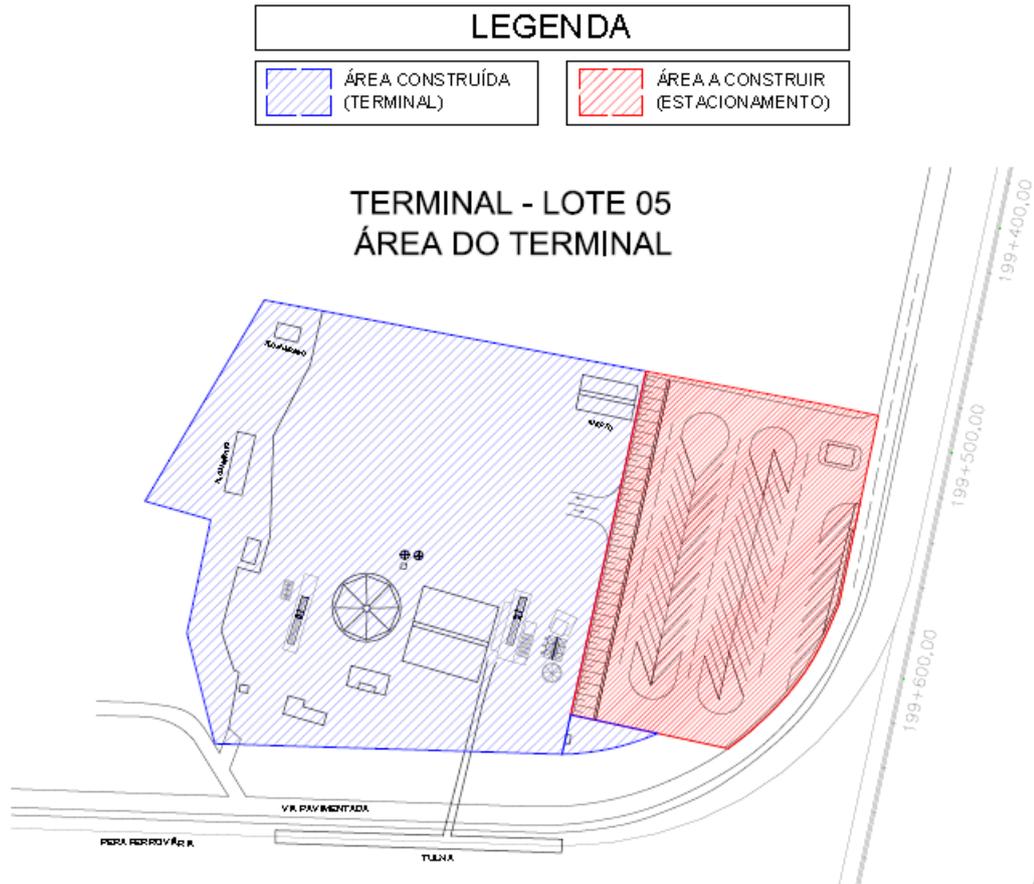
Planta da área de estudo com estruturas instaladas e previstas
